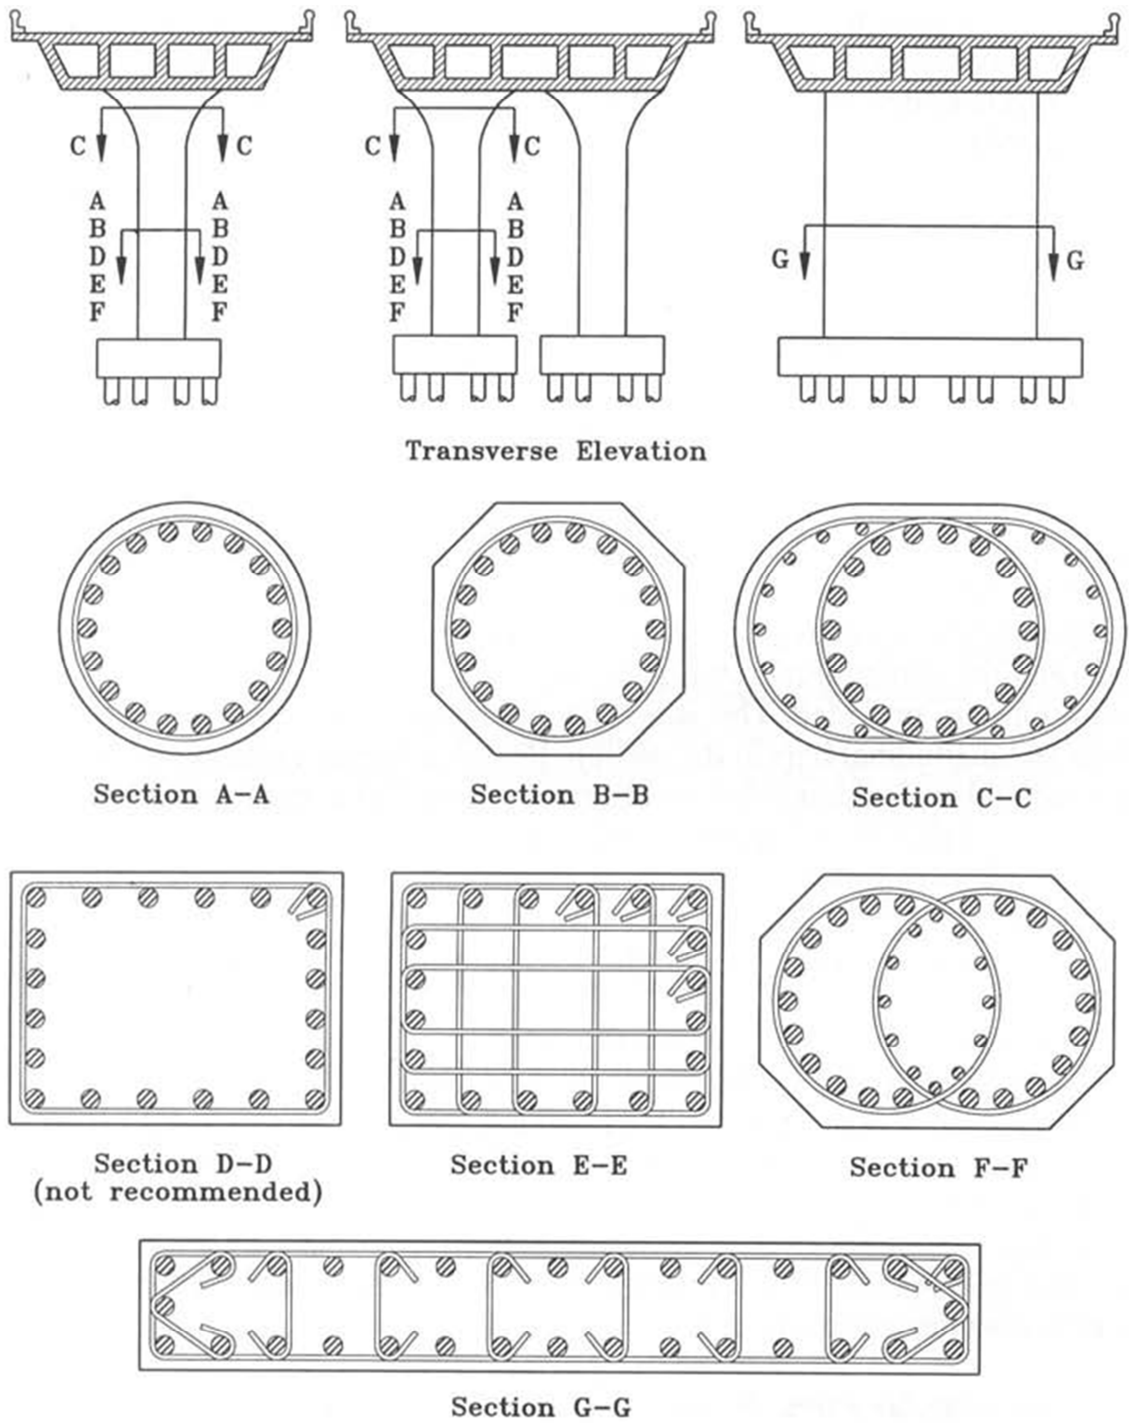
Secciones transversales típicas de columnas solidas (Tomado de Priestley, Seible y Calvi, 1996)
